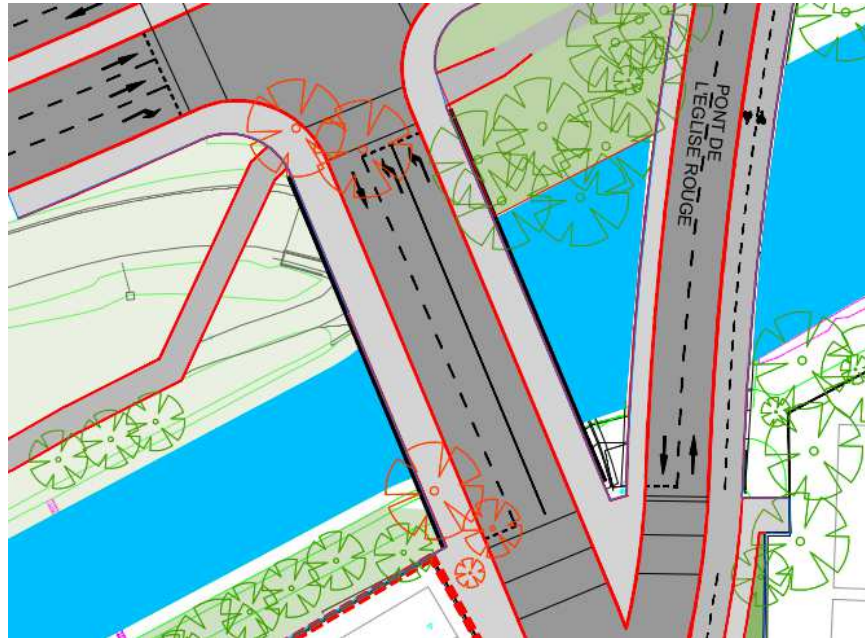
vue en plan du nouvel ouvrage Eglise Rouge
